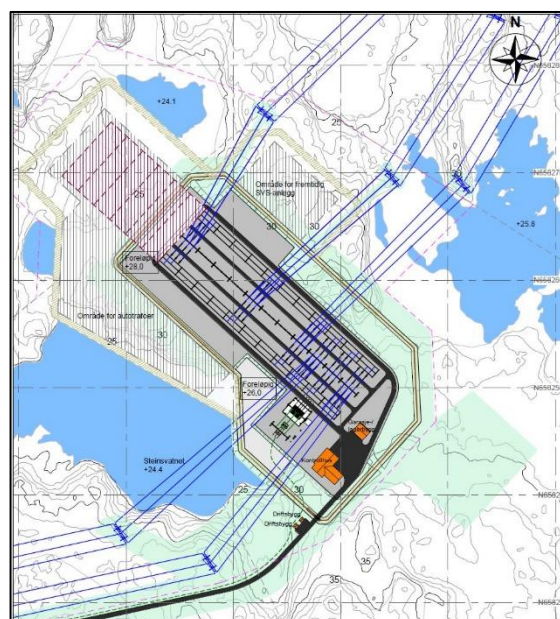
Plan for utvidelse av eksisterende Blåfalli koblingsanlegg.
